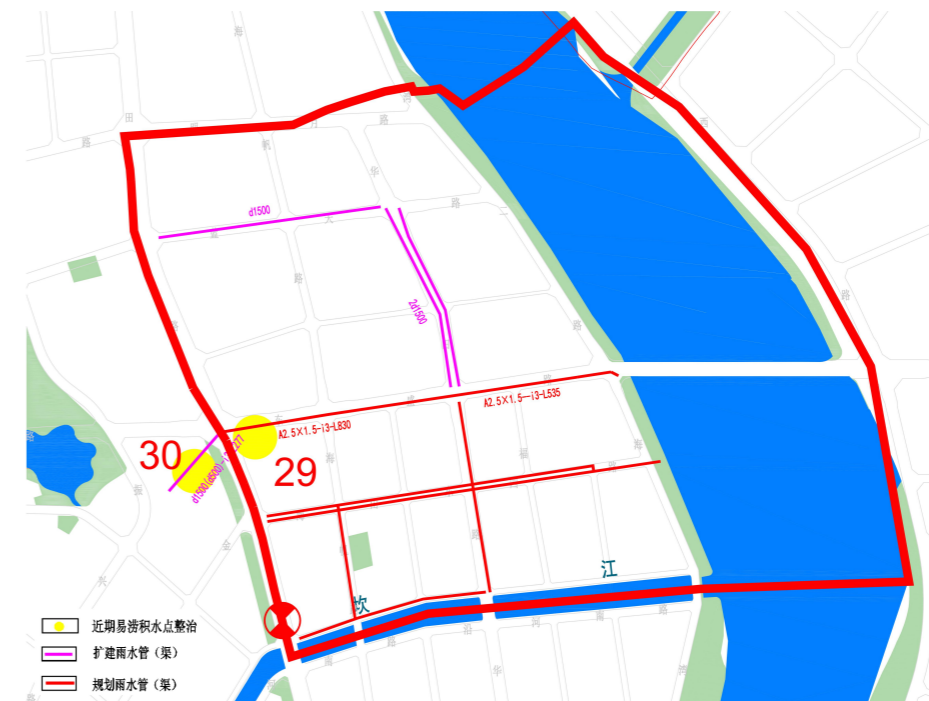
赤坎滨湖分区近期新、改扩建雨水管渠平面图
